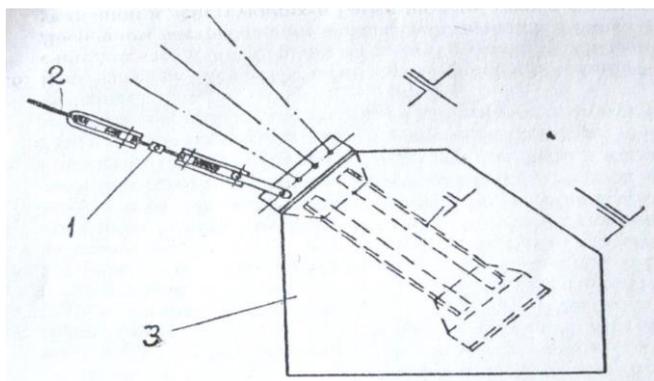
Конструкция крепления оттяжек кустовых мачт к анкерному устройству:
